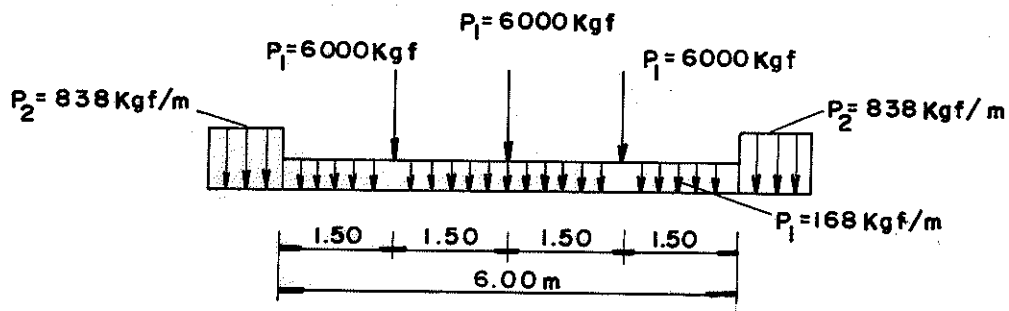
CARGA MÓVEL SOBRE A VIGA PRINCIPAL
